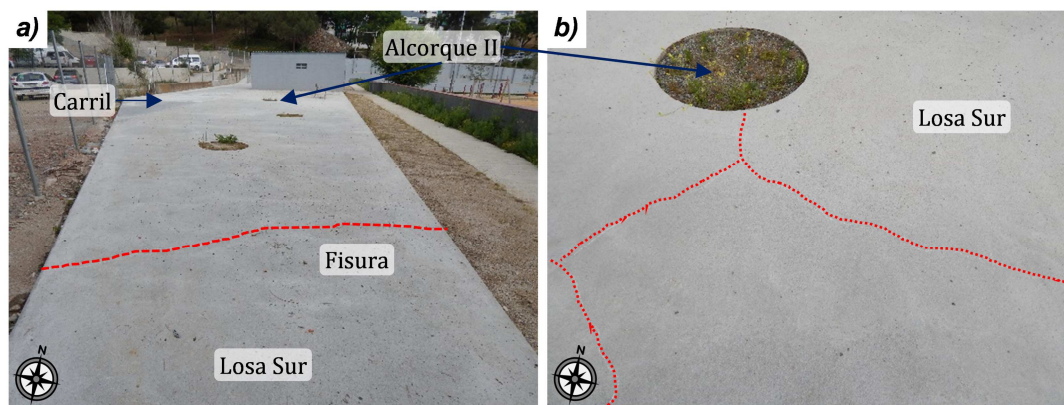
75 – Losa Sur; a) fisura de rotura de punta; b) fisuras de unión entre alcorques
